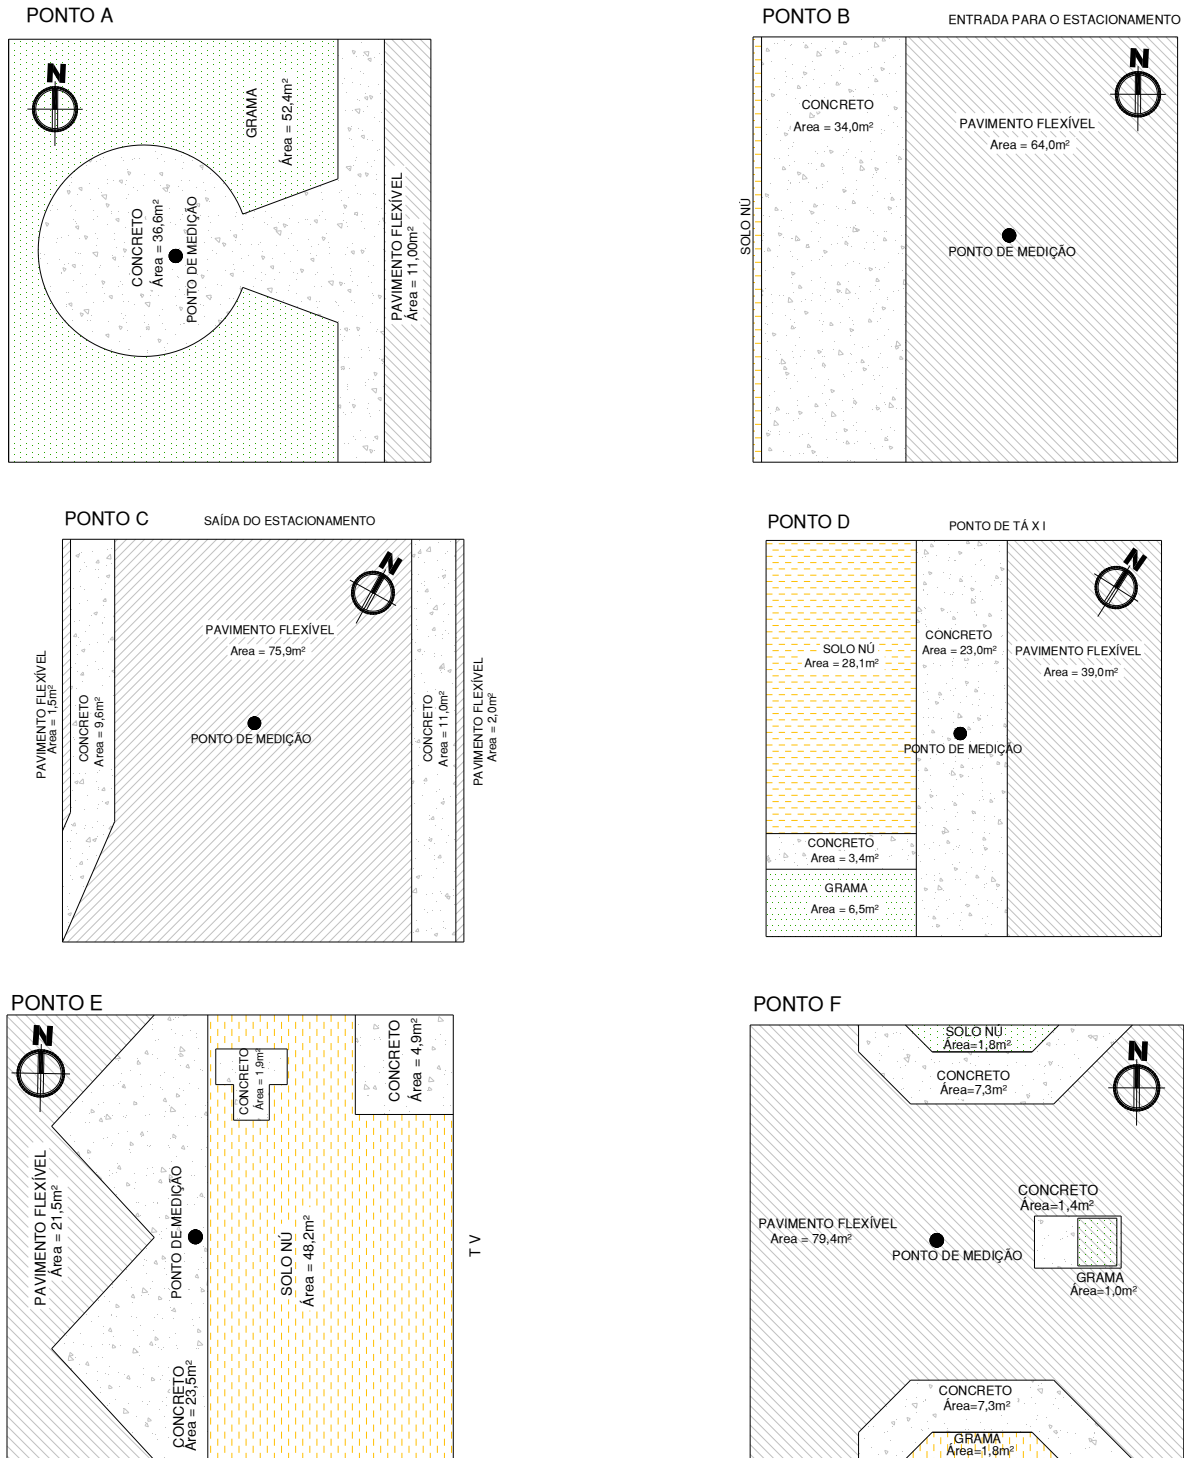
Pavimentação do entorno dos pontos de medição e indicação do ponto de medição.
